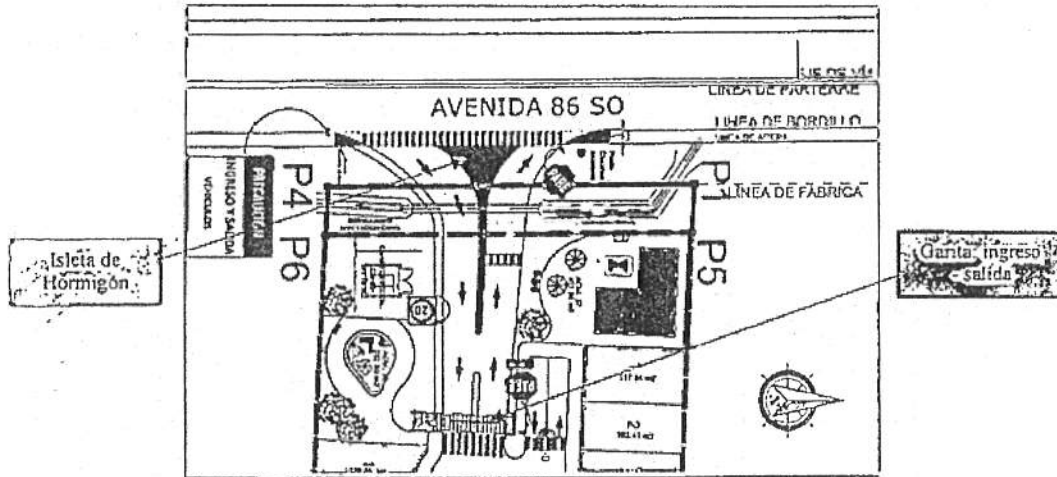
Acceso al Proyecto “Urbanización Mirabella”
